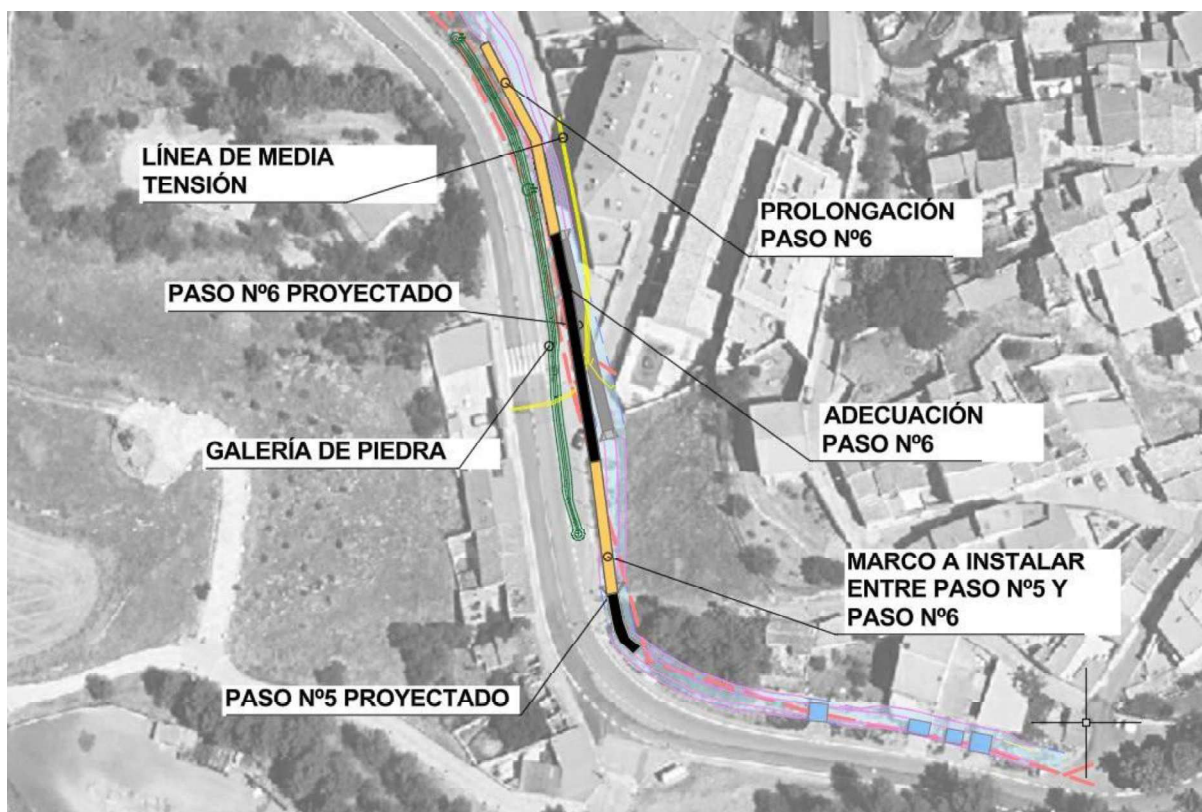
Planta de actuaciones contempladas en proyecto modificado.
